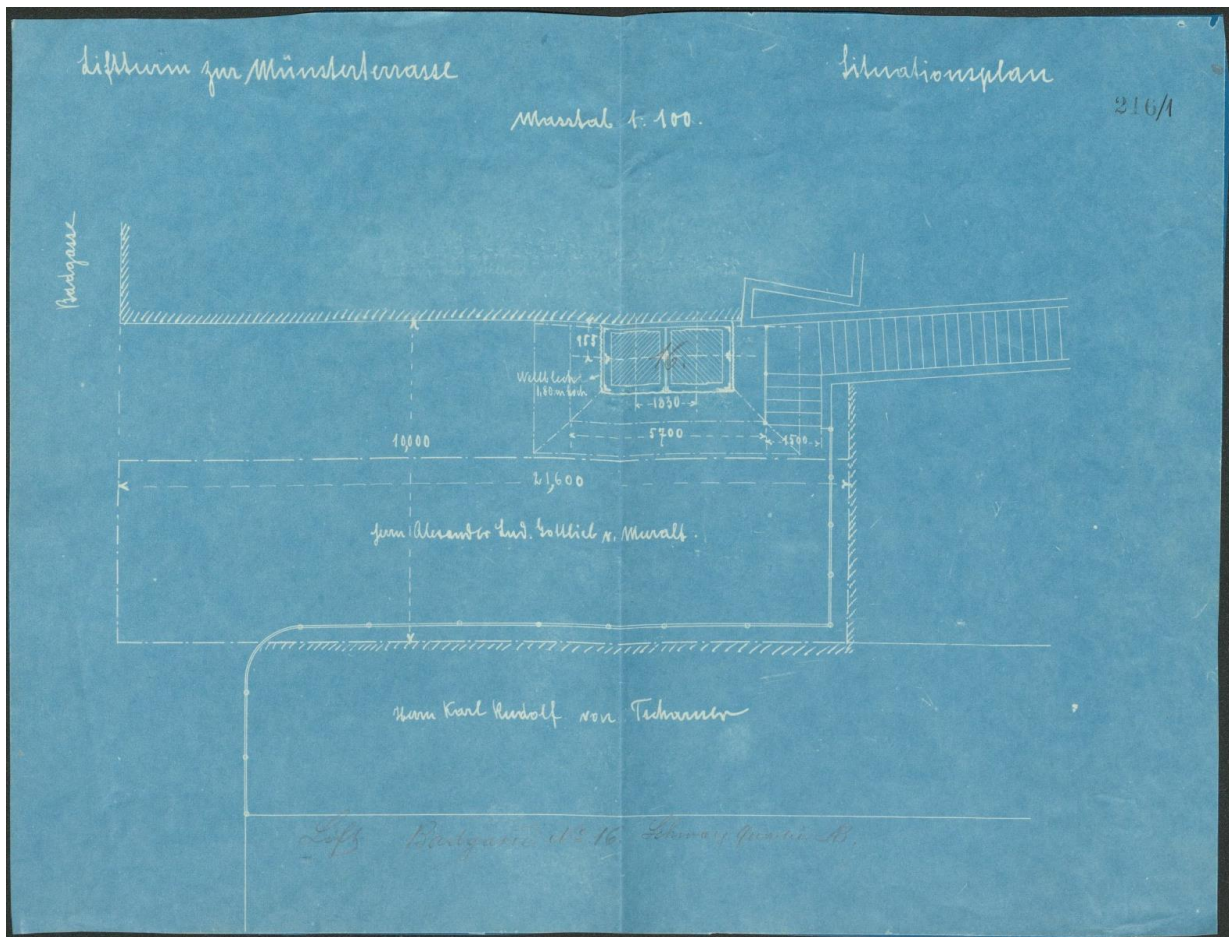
Situationsplan Liftturm zur Münsterterrasse (Massstab 1:100)
